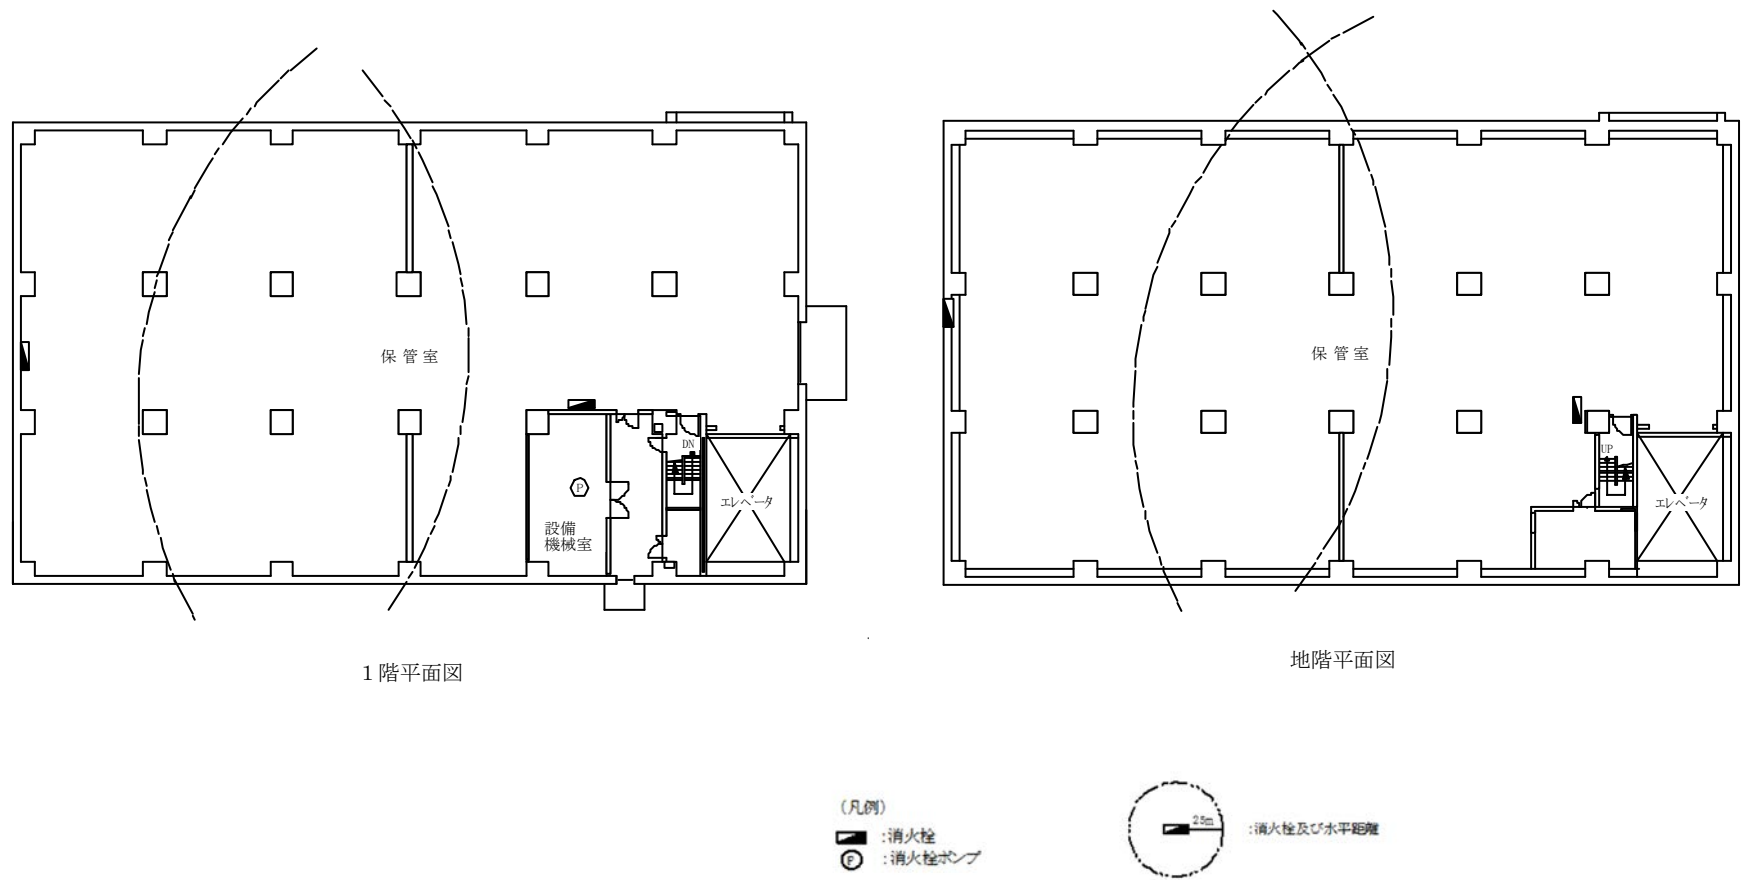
固体集積保管場Ⅳ 屋外内消火栓配置図
